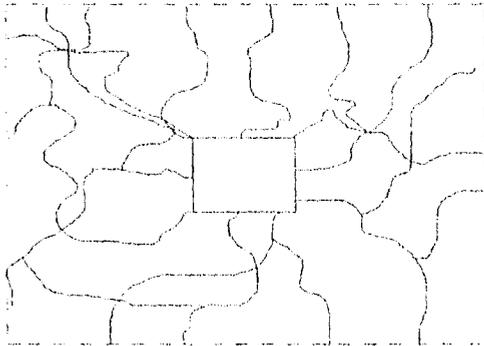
II AGRIETAMIENTO DE UNA LOSA PLANA.
